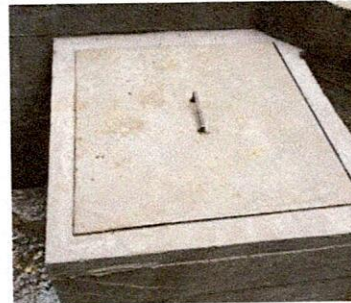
Suministro, transporte e instalación de Tapa en concreto reforzado con marco metálico de 0,60x0,60 m, incluye elementos de anclaje y anticorrosivo
